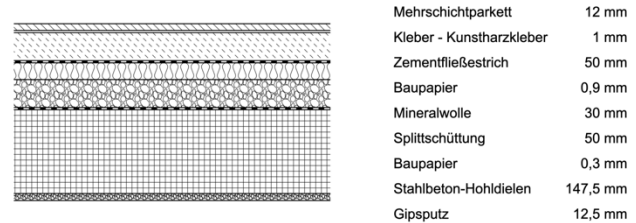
Detail Deckenaufbau Stahlbeton-Hohldielendecke (maßstabslos)
